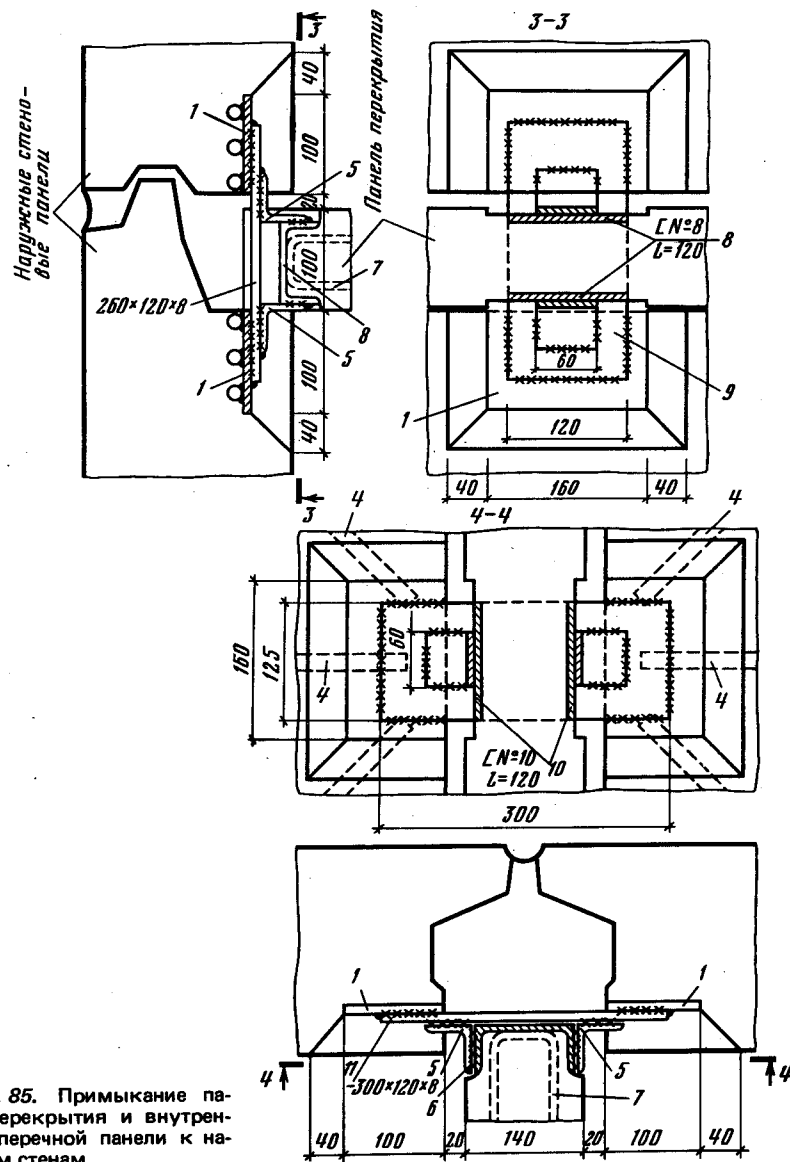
Примыкание панели перекрытия и внутренней поперечной панели к наружным стенам
